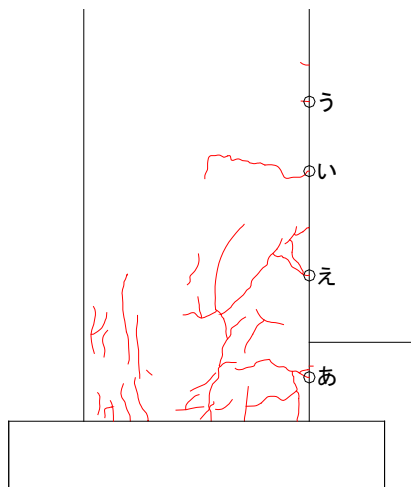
柱ひび割れ幅測定位置(試験体 A-7a 負荷荷)
